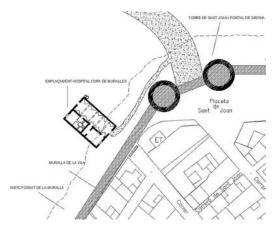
Situación del primer edificio del Hospital fuera de las murallas s XVI–XVII (Ferran Sintes)
